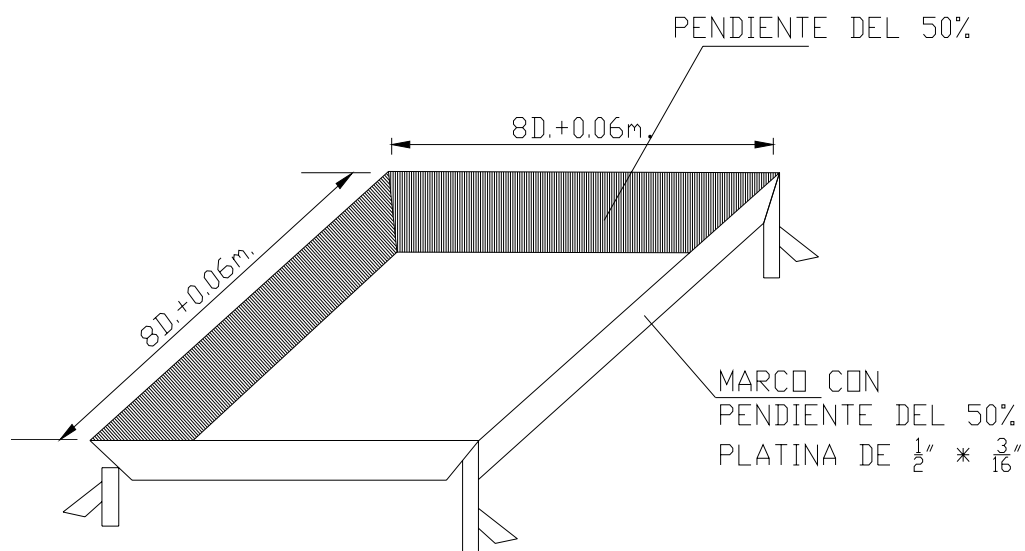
Marco de caja inspección sencilla en B.T. Vista general.
